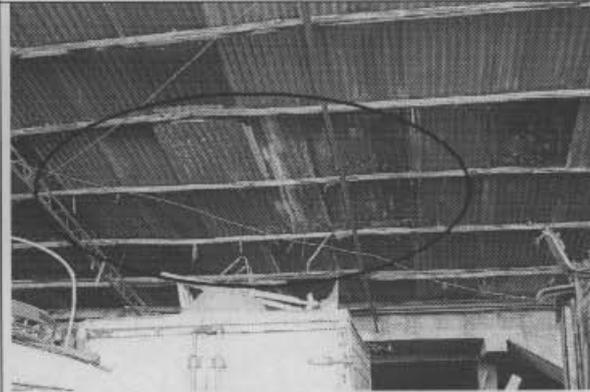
Madera rolliza que sirve como correa en la estructura de cubierta.
